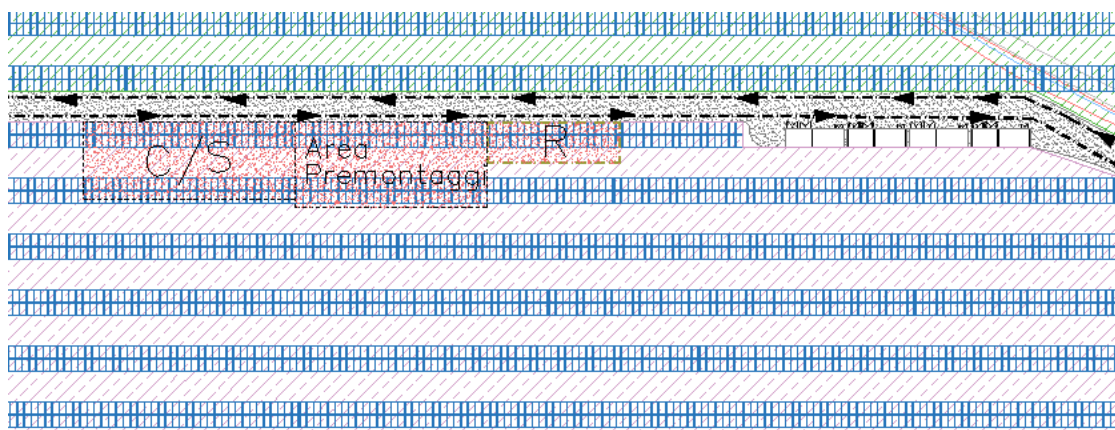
Dettaglio area di accantieramento "Ozzano 4"
